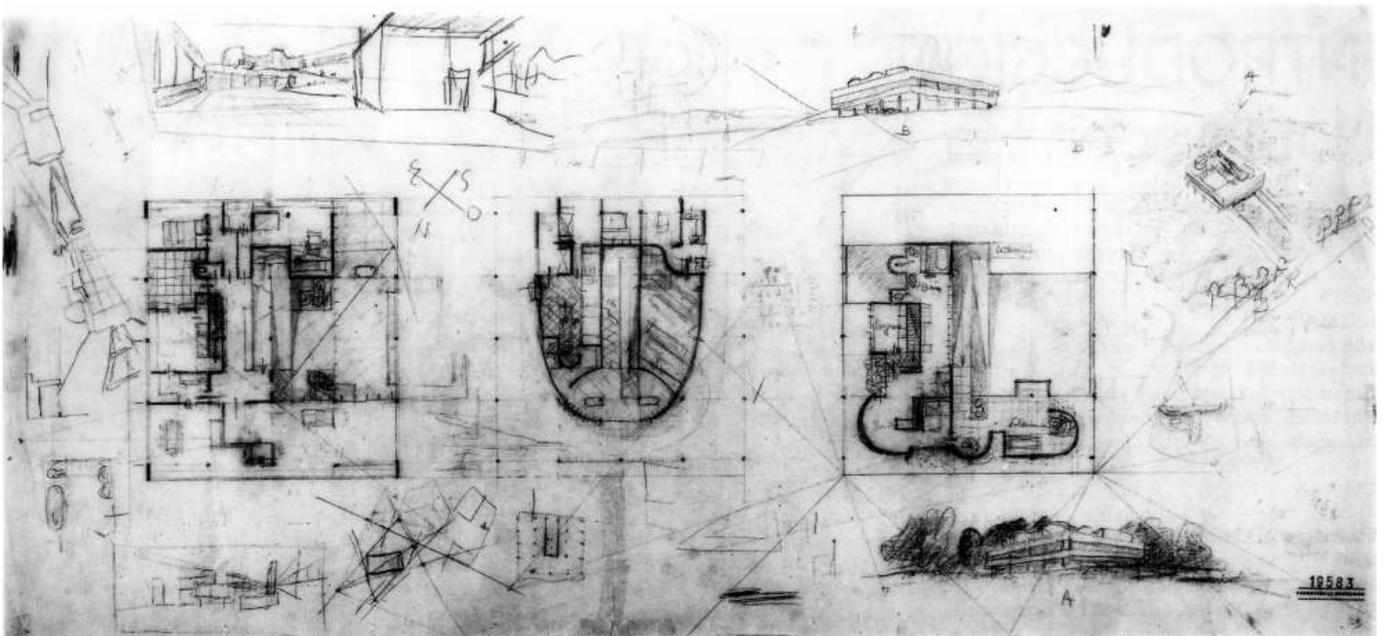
Primer croquis de la Villa. (FLC 19583)
